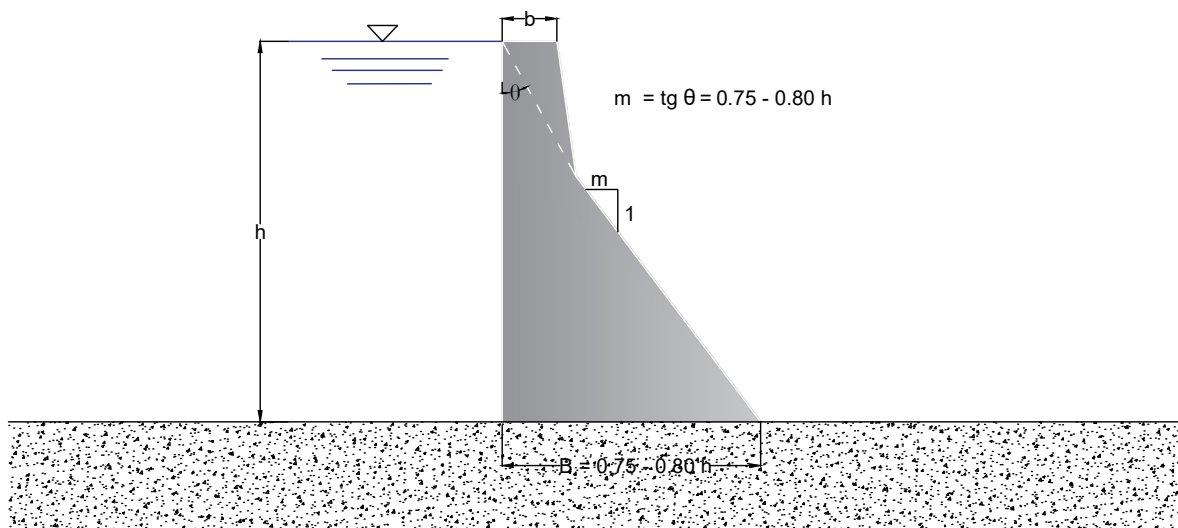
Perfil típico de uma barragem gravidade de concreto.
